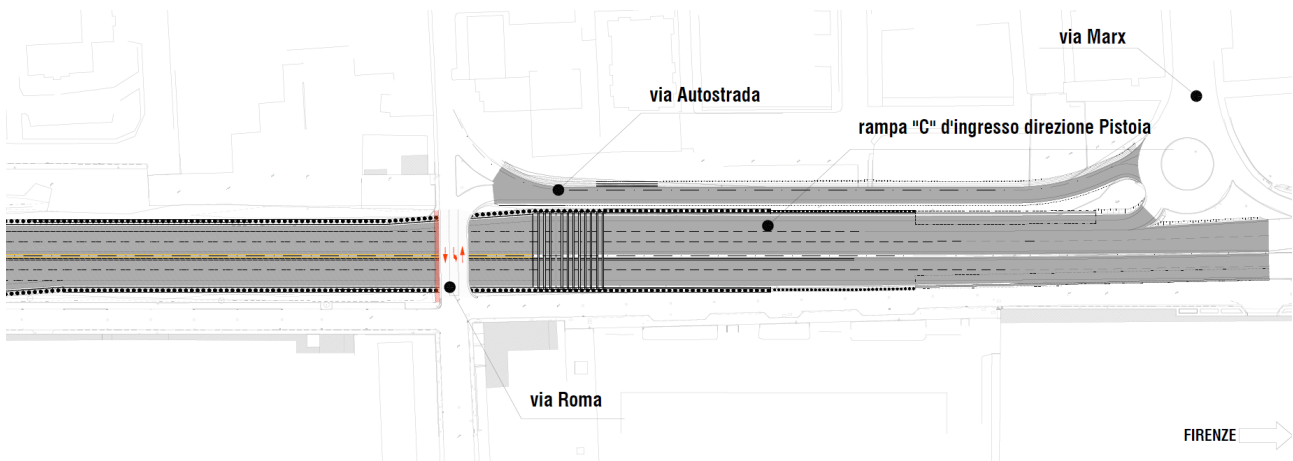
Stralcio della planimetria di progetto con la rampa "C"
